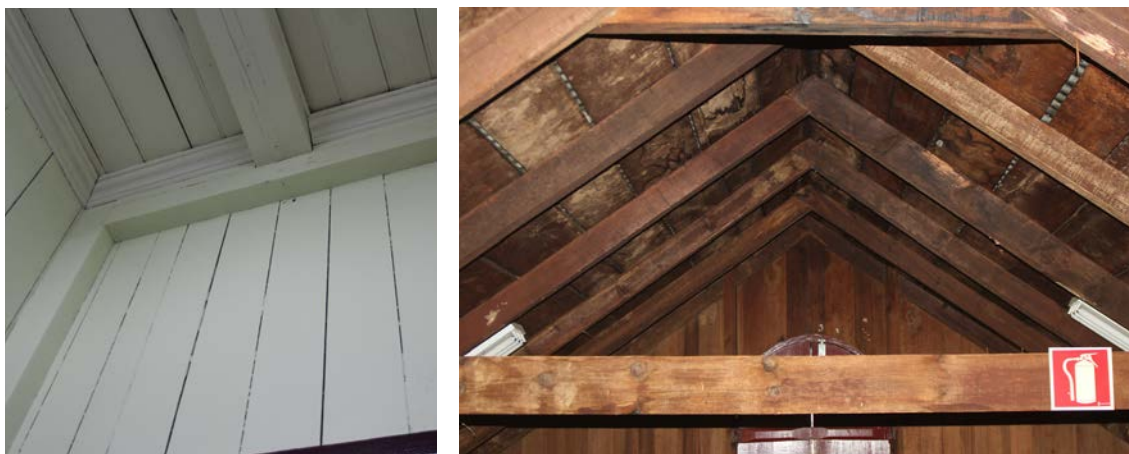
Fotografía del distribuidor de segunda planta en la Casa Bocchese, donde se aprecia los ensambles de las piezas que componen el pórtico central.
